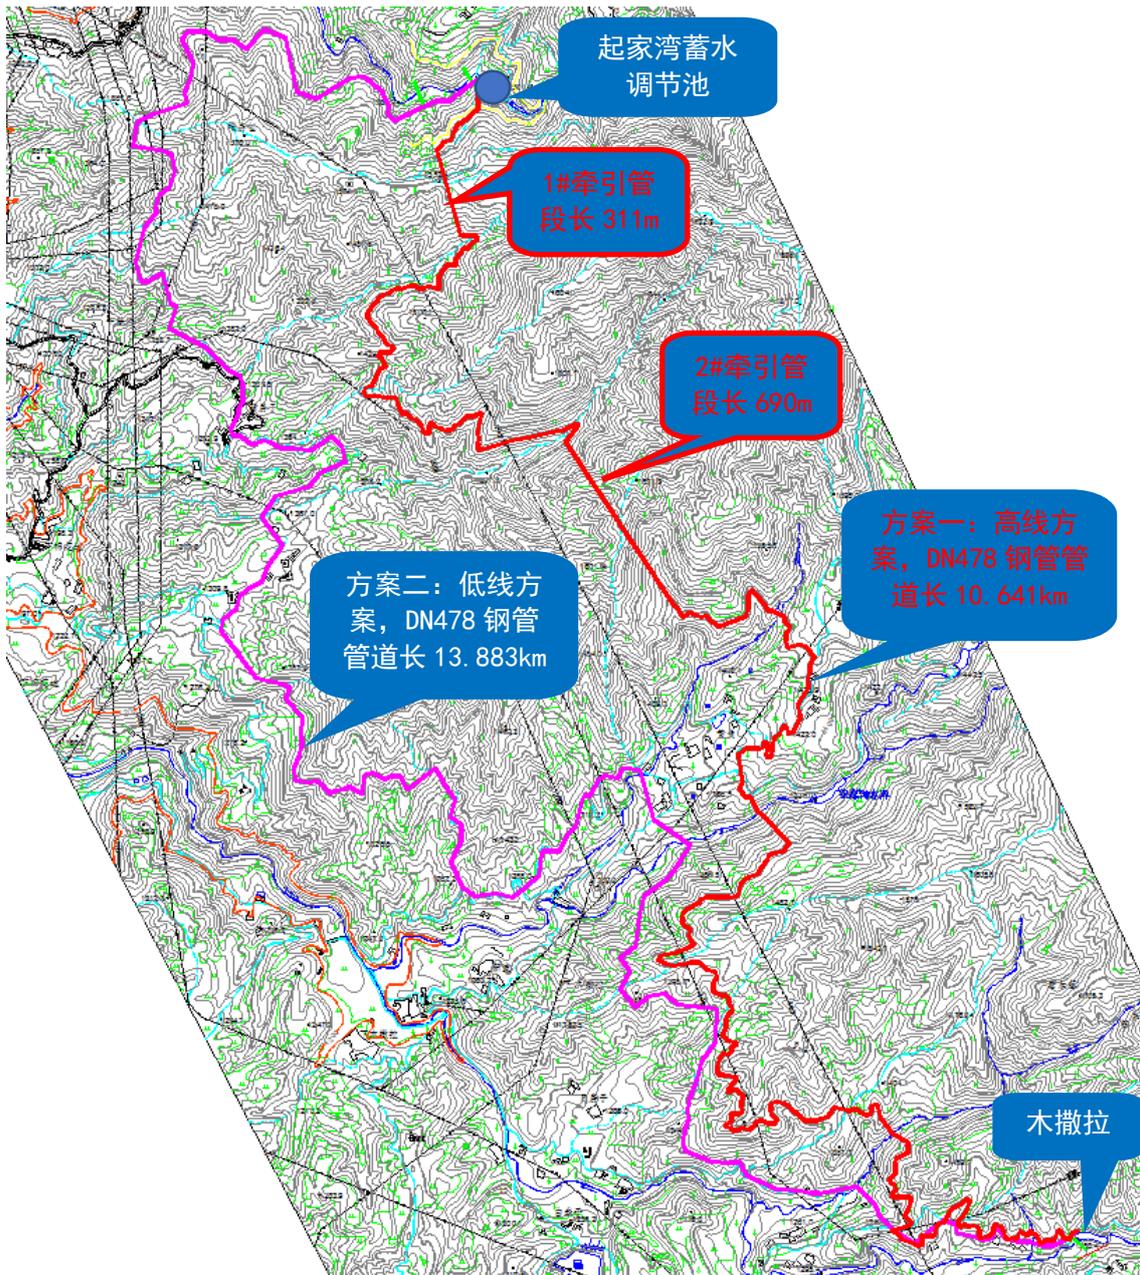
起家湾至木撒拉段管线方案比选平面布置图
